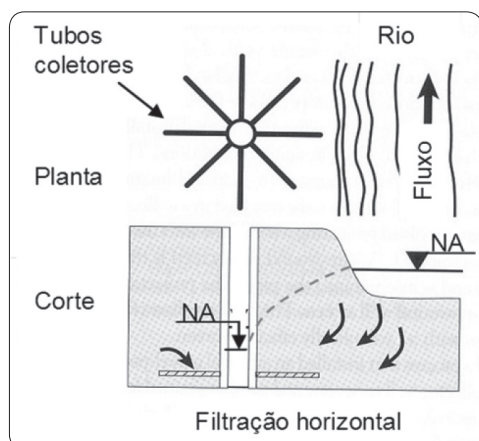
Planta e corte de um sistema alternativo de FMR: poço de coletores horizontais (Fonte: adaptado de Hunt, H.; Schubert, J. e Ray, C., 2003)
